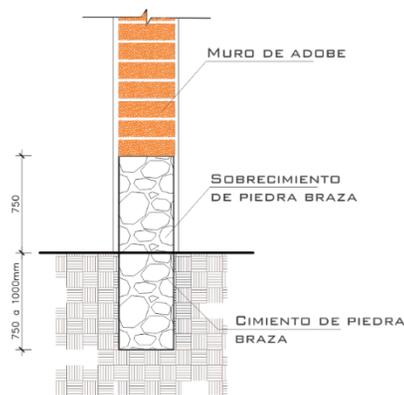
Detalle de cimentación. Fuente: Elaborado por GALS
